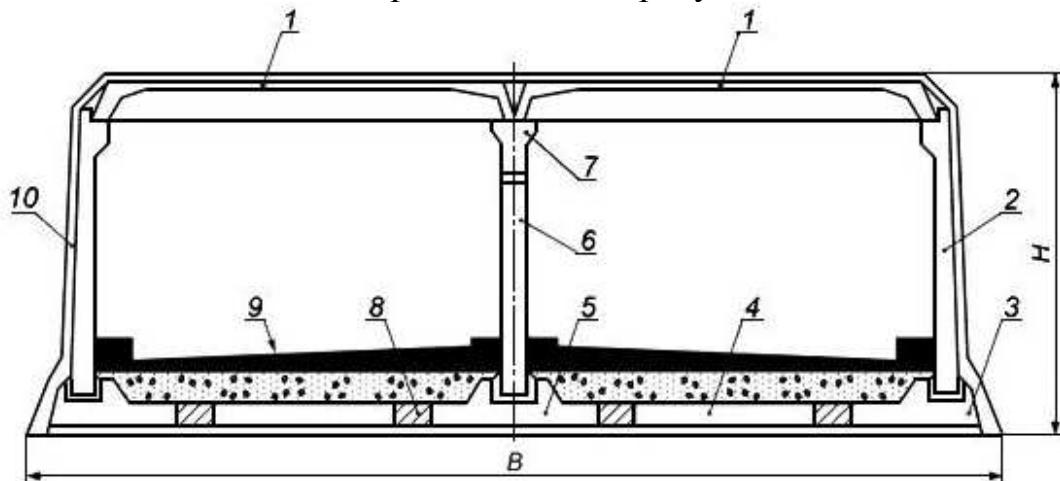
Типовая конструкция автотранспортного тоннеля из сборных железобетонных элементов
